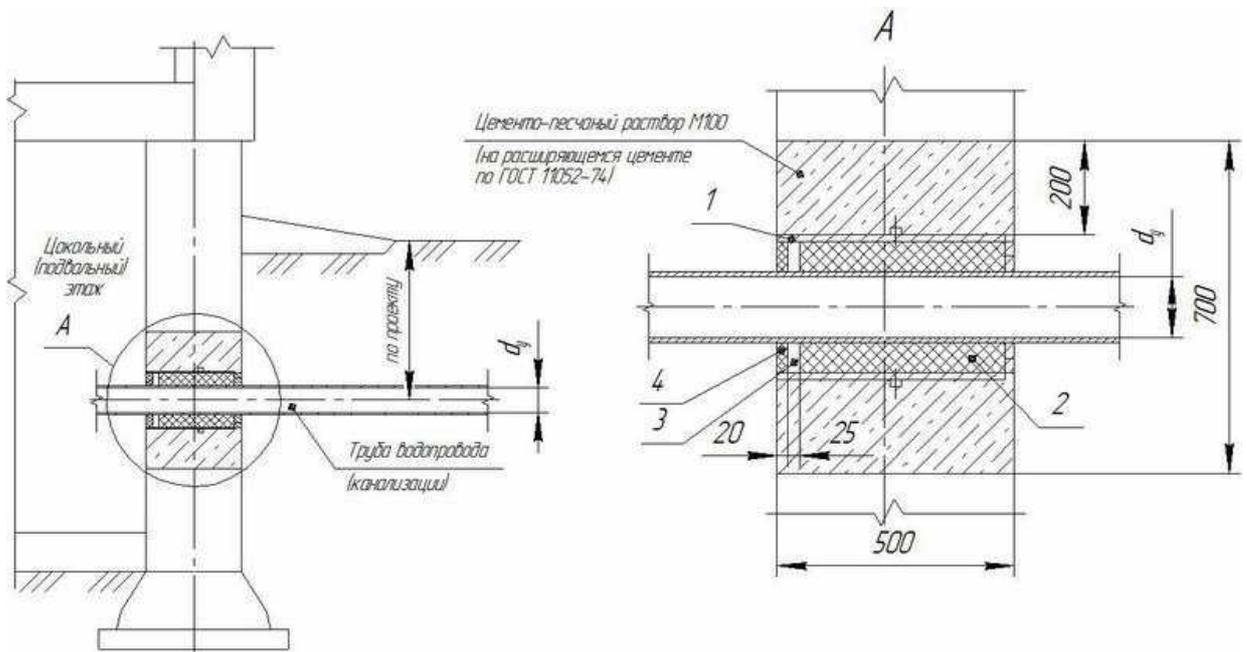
Ввод водопровода через стену подвала в сухих грунтах
